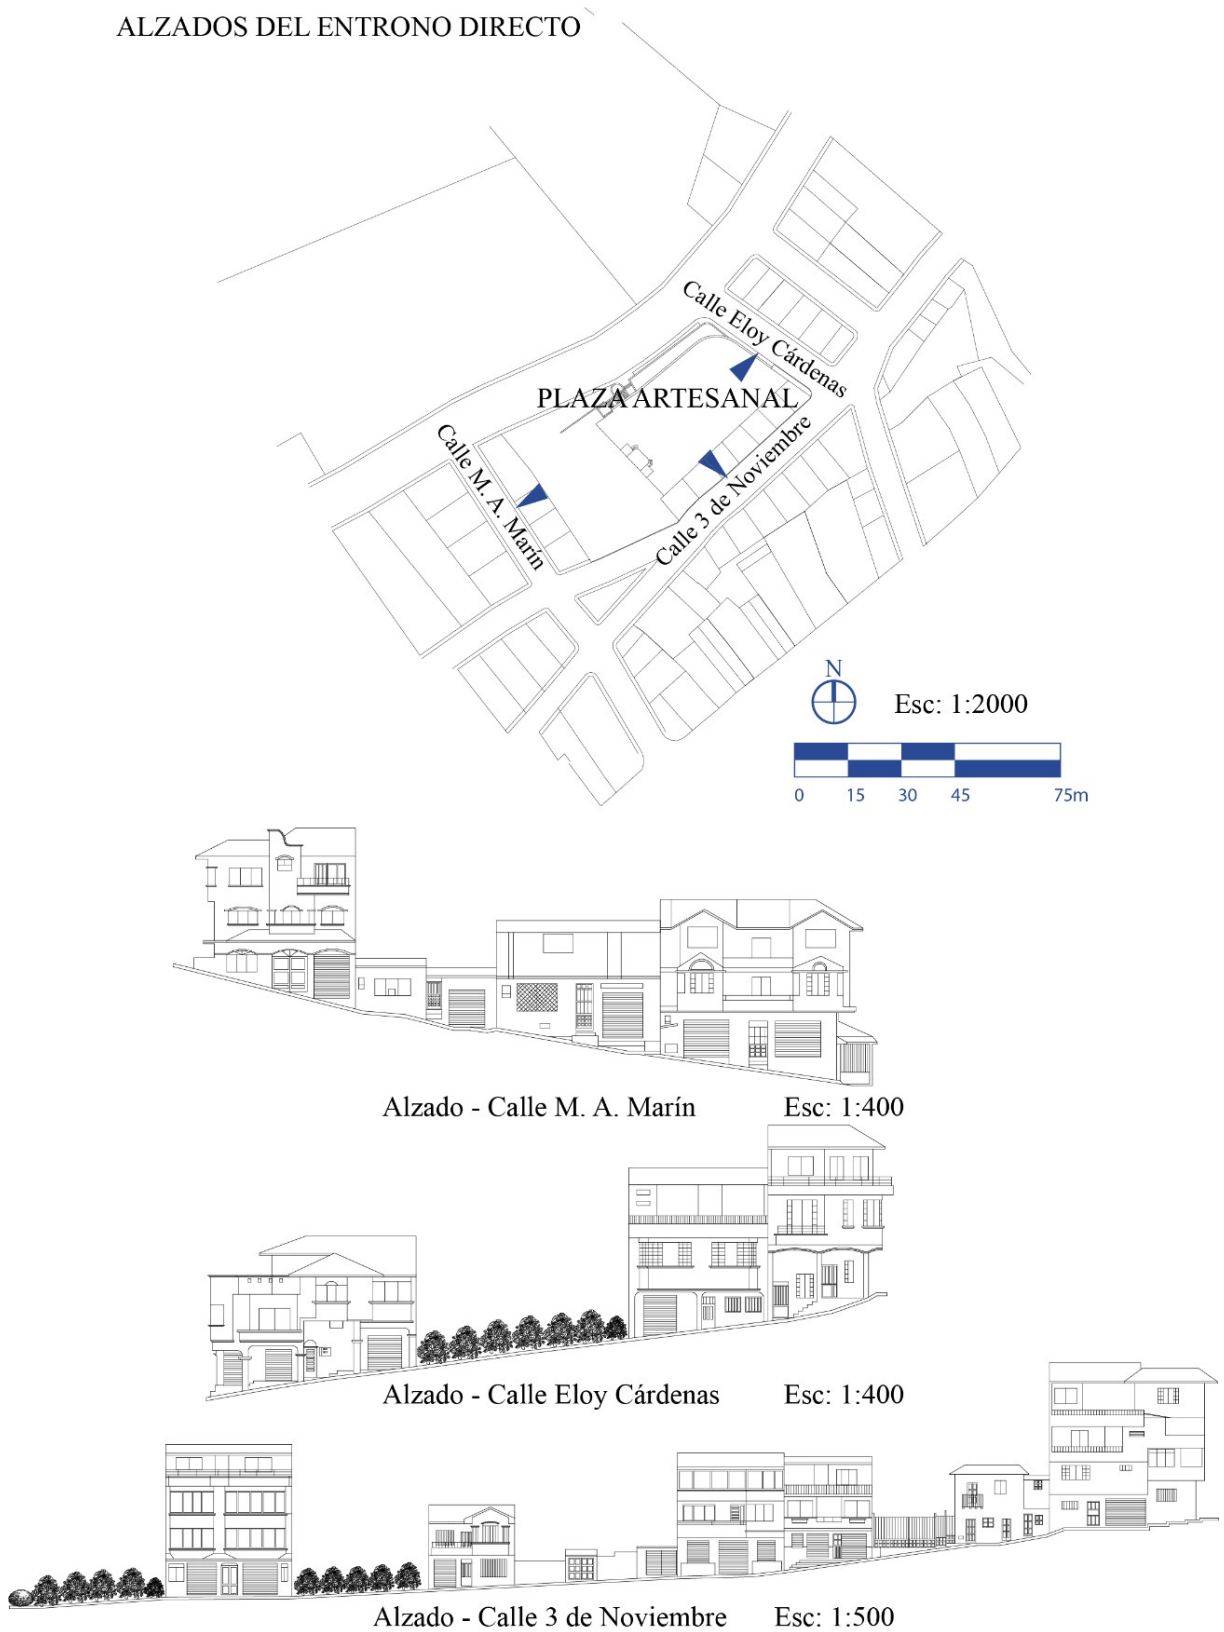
Alzados de las fachadas del lugar. Fuente y elaboración: Autor.
